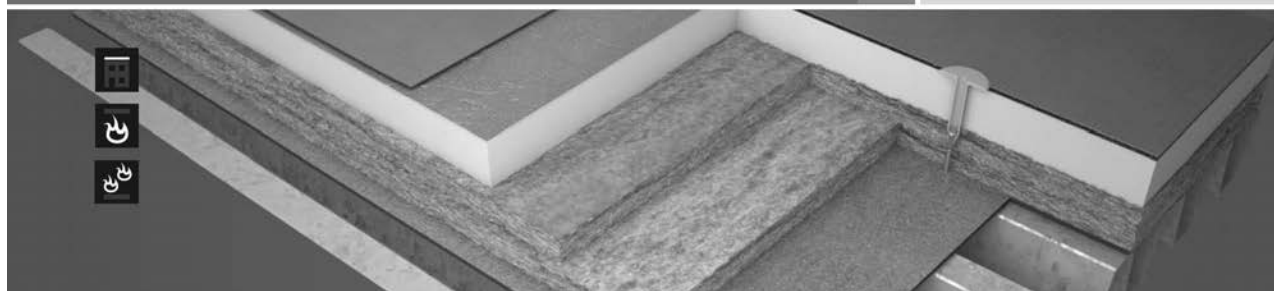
Detail u vtoku (skladba DEKROOF 09-B)
